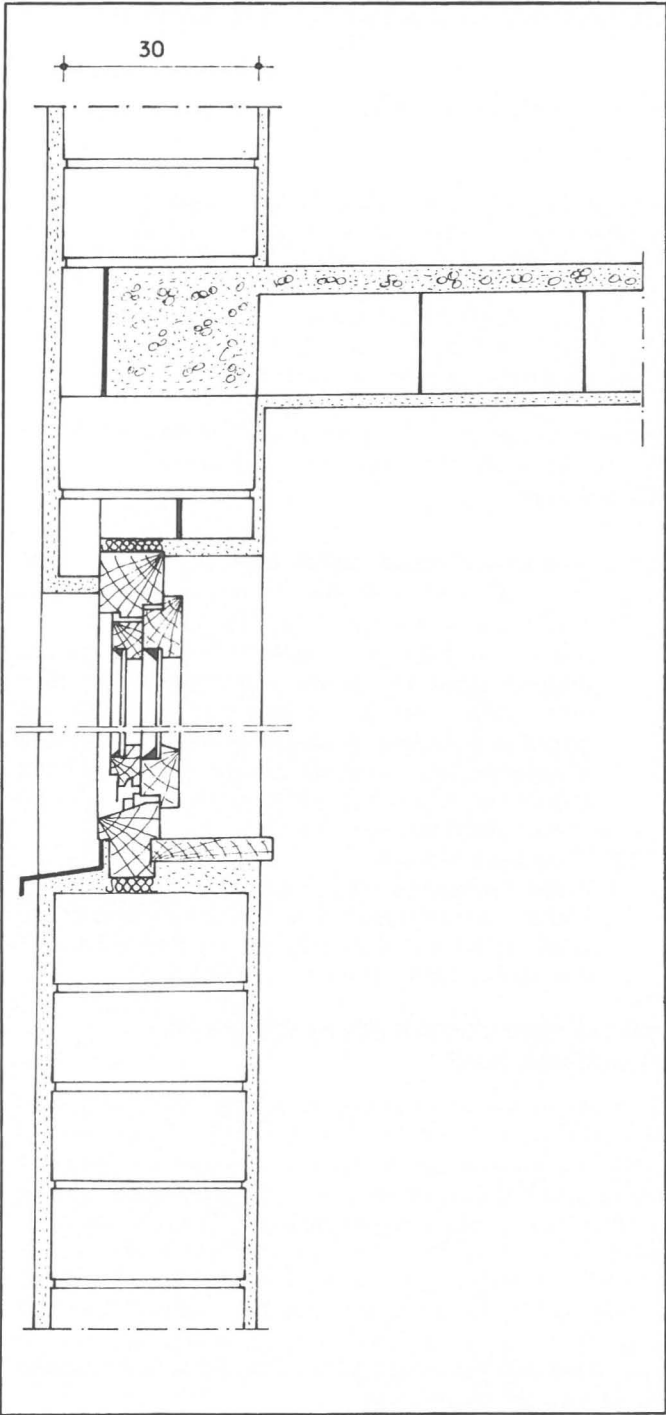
Fenstereinbau und Verkleidung des Deckenrandes bei einer Vollwand. (Österreich)
